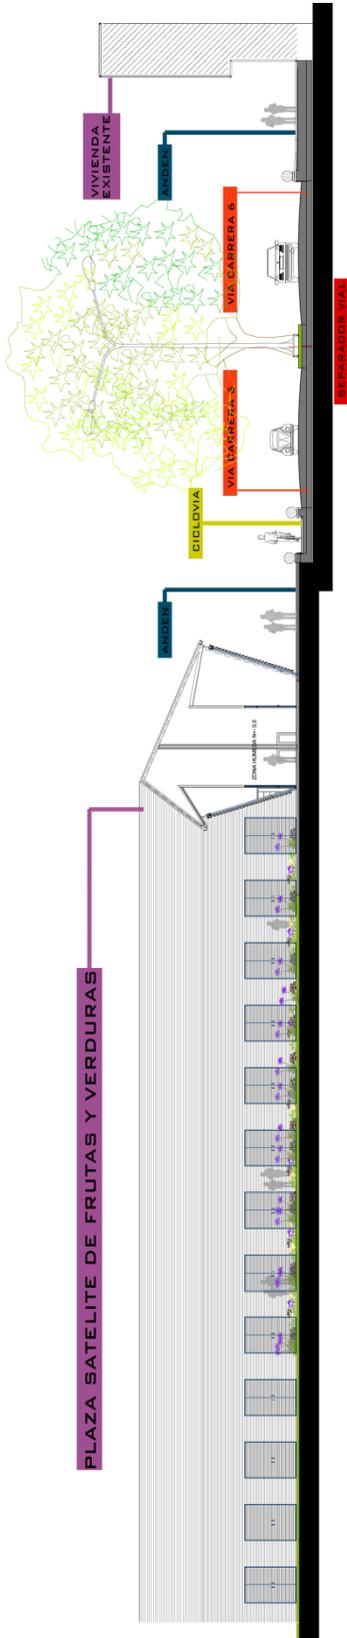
Plano Propuesta Arquitectónica 1 Piso Plaza Satélite de Frutas y Verduras
